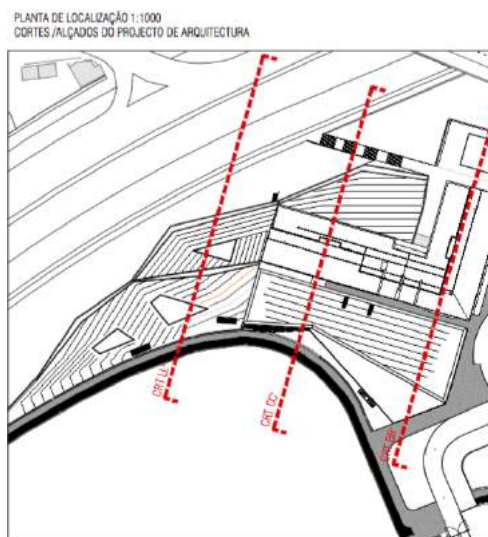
Planta da Cobertura, Cortes (adaptado de PROAP)
